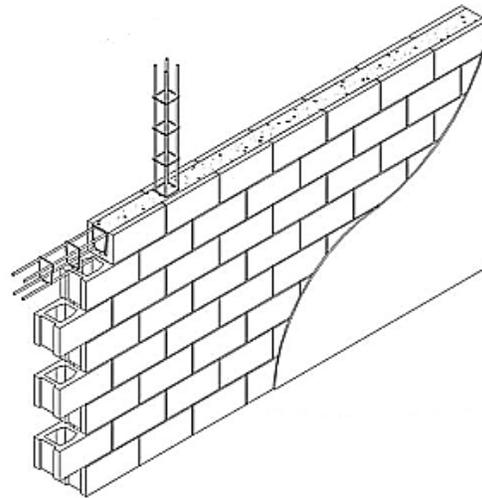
Ejemplo de muro de mampostería de block con elementos de amarre de concreto armado.
